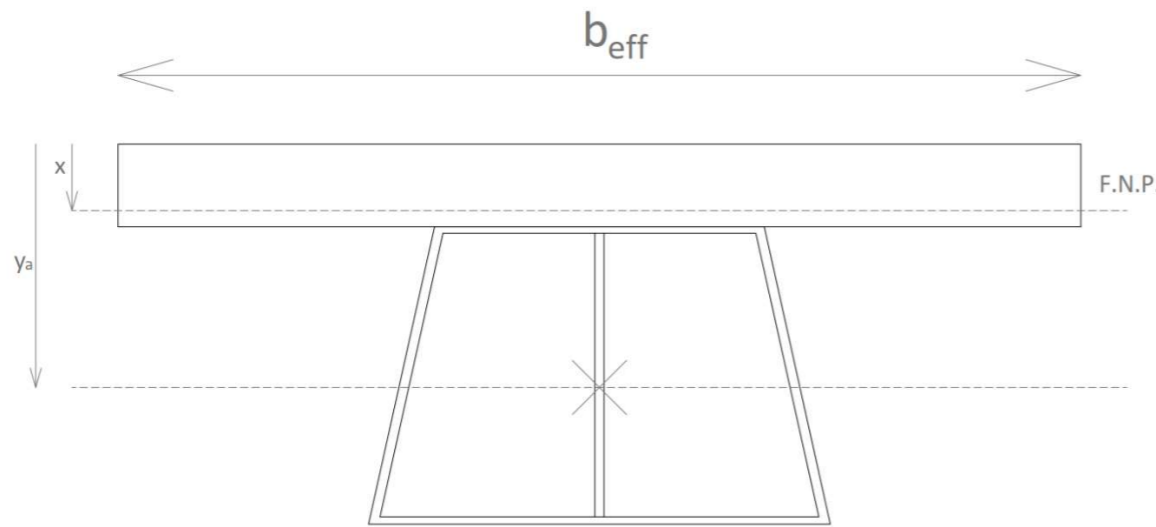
Fibra neutra plástica en la losa de hormigón de la viga longitudinal (fuente: elaboración propia)
